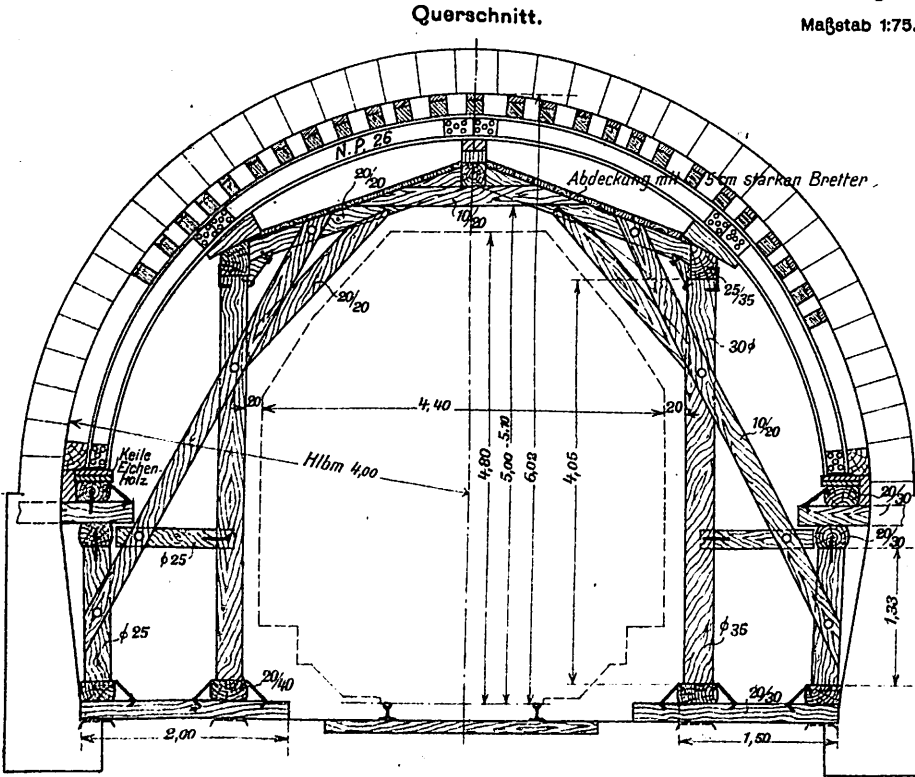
Einrüstung des Tunnels. Maßstab 1:75.
